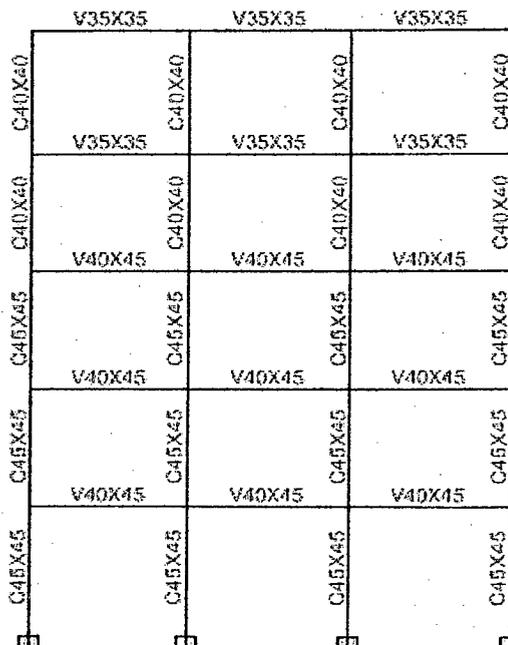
ELEVACIÓN B (Sección de columnas y vigas)
